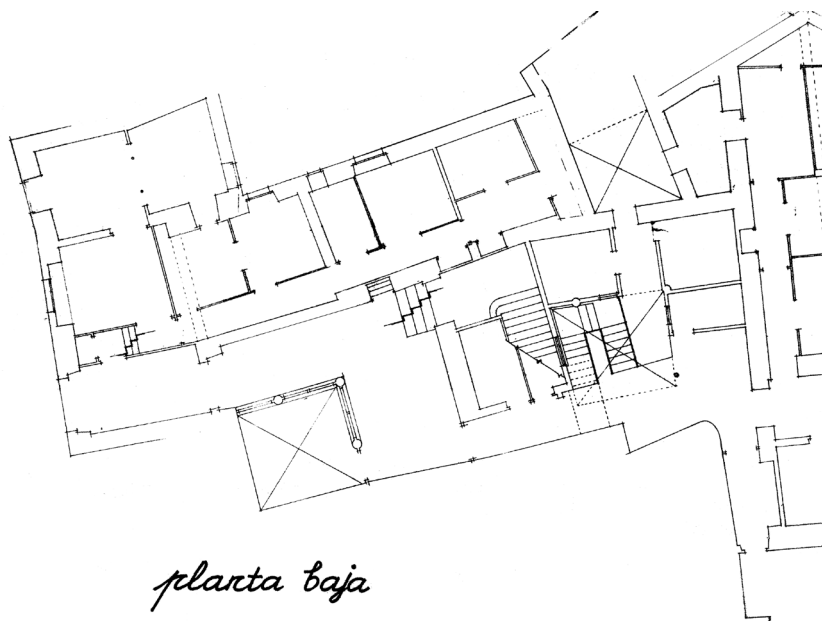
Sede de Acción Católica Masculina. Plano de planta del estado previo. AHPza. DPV. 11/35. Foto: RAG-L.
